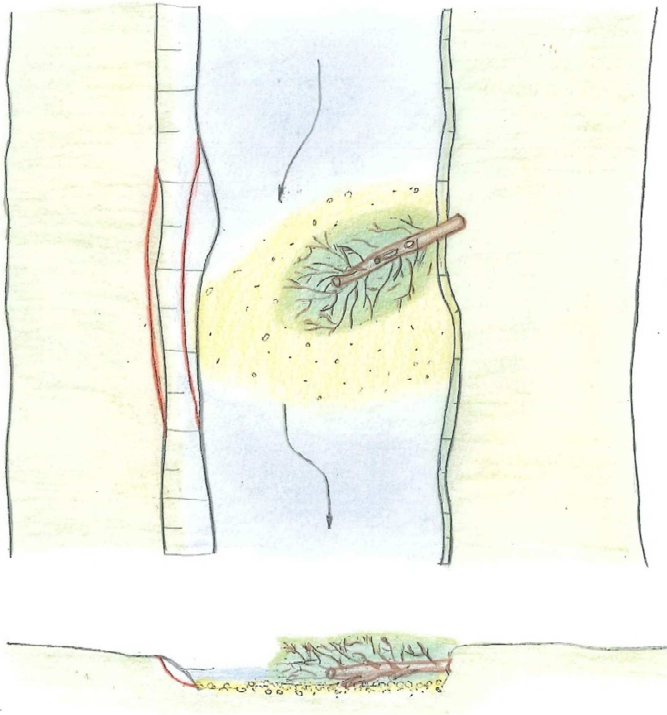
Sturzbaum/ Totholz mit Kieseinbau
